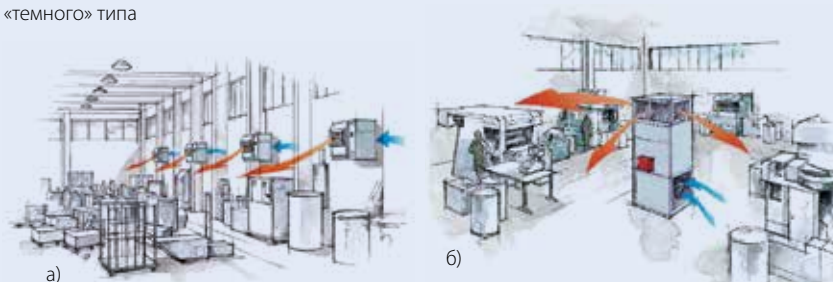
Газозвушное отопление производственных помещений. Варианты конструктивных решений: а – настенное, б – напольное
